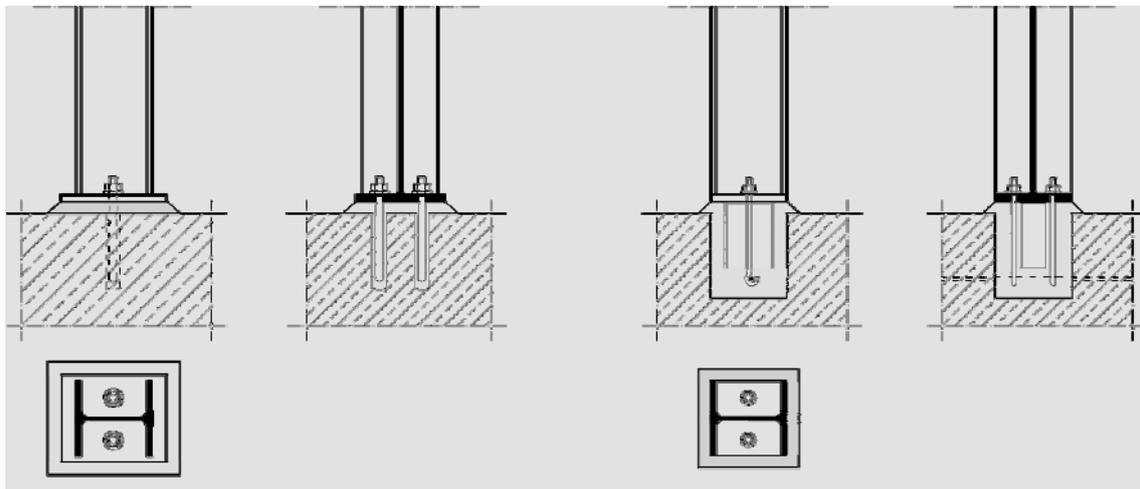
Exemple classiques de pieds de poteaux articulés dans un portique
